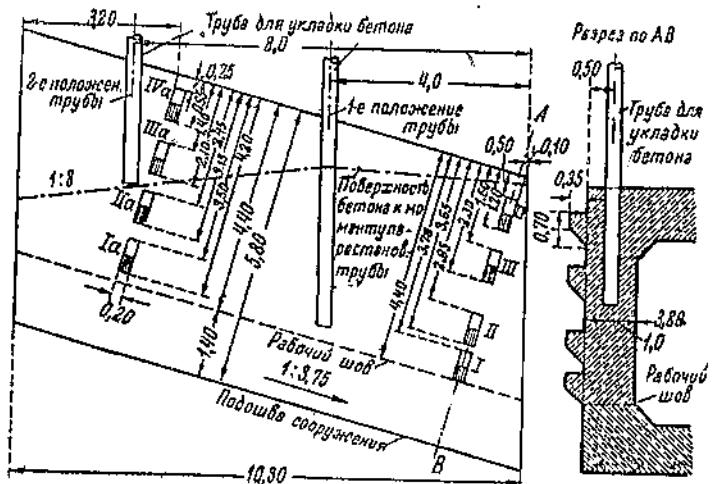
Схема расположения труб для бетонирования дюкера с помощью вертикально-перемещающейся трубы.
